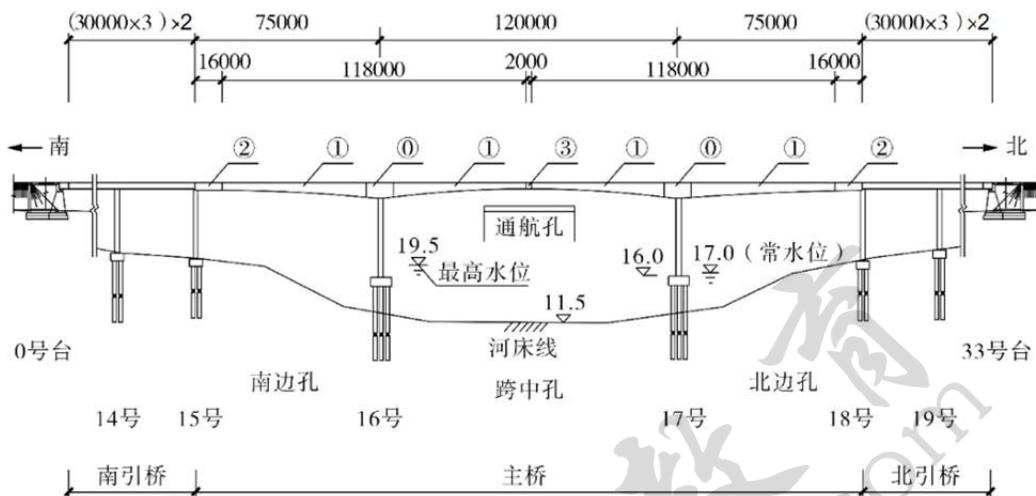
桥梁立面布置及主桥上部结构施工区段划分示意图（高程单位：m；尺寸单位：mm）
